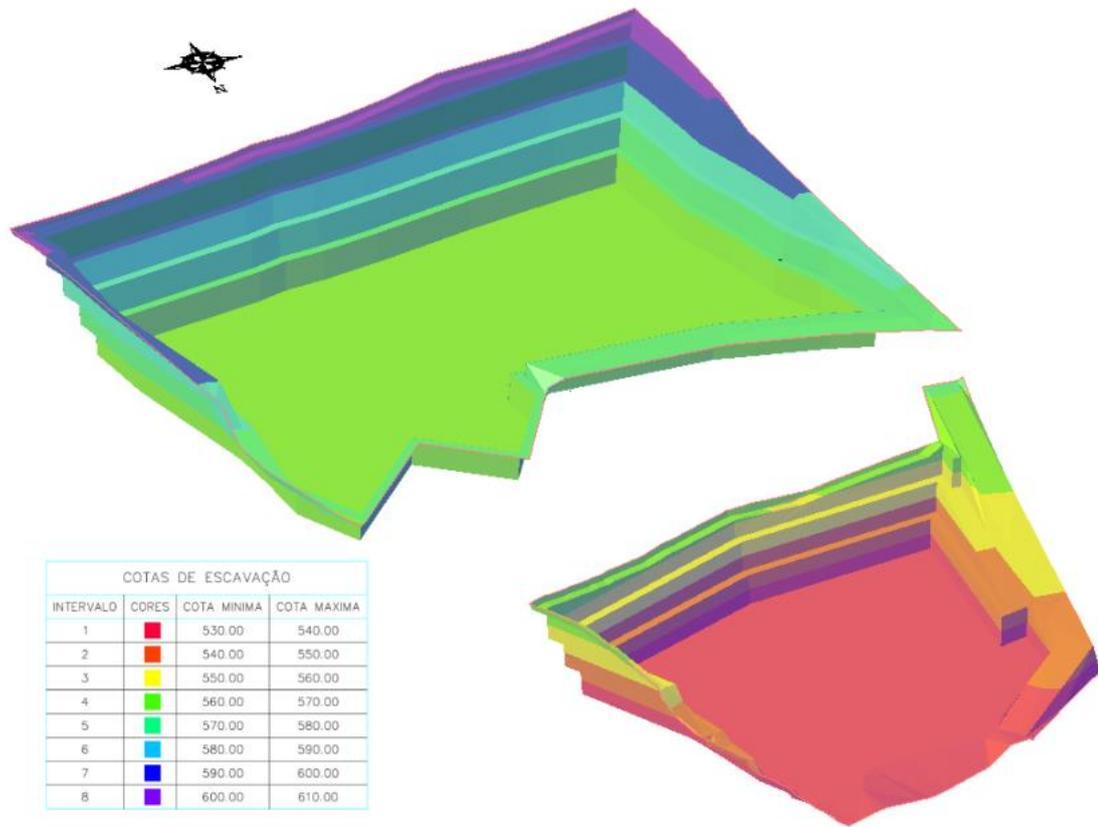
Aspeto final da exploração. Fonte: Plano de Lavra
